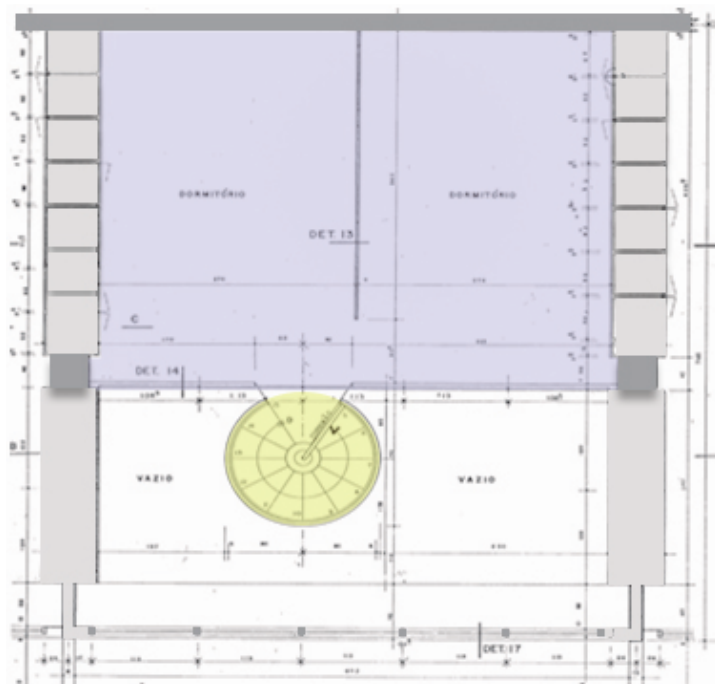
Alojamento UnB – Planta Pavimento Superior da Unidade
